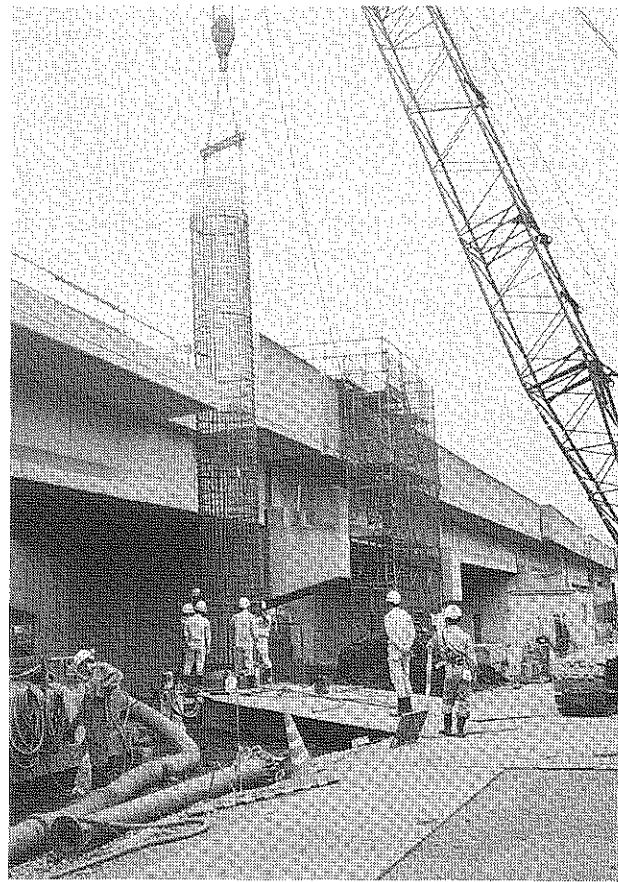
7 - 5 橋脚 P 1 基礎杭施工中
